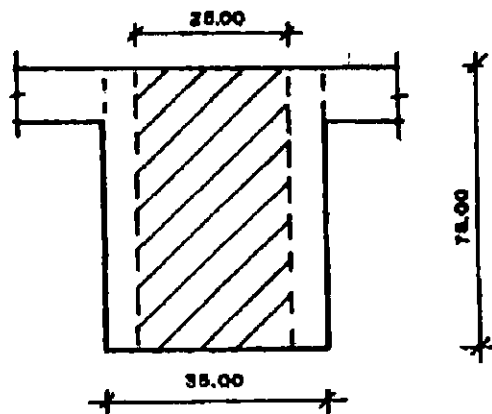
Nueva sección para viga eje 1, tramo B-C, Nivel 1.
